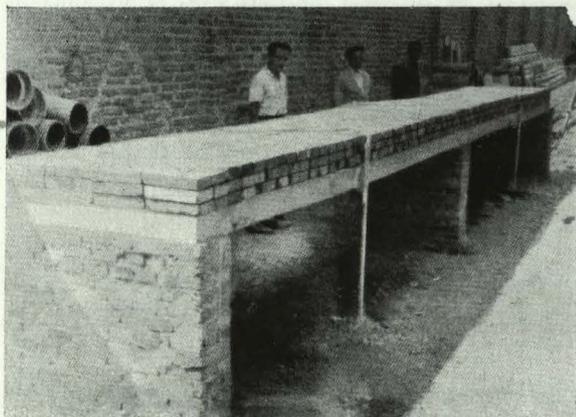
Losa de ensayo con sobrecarga de 270 kg/m²
